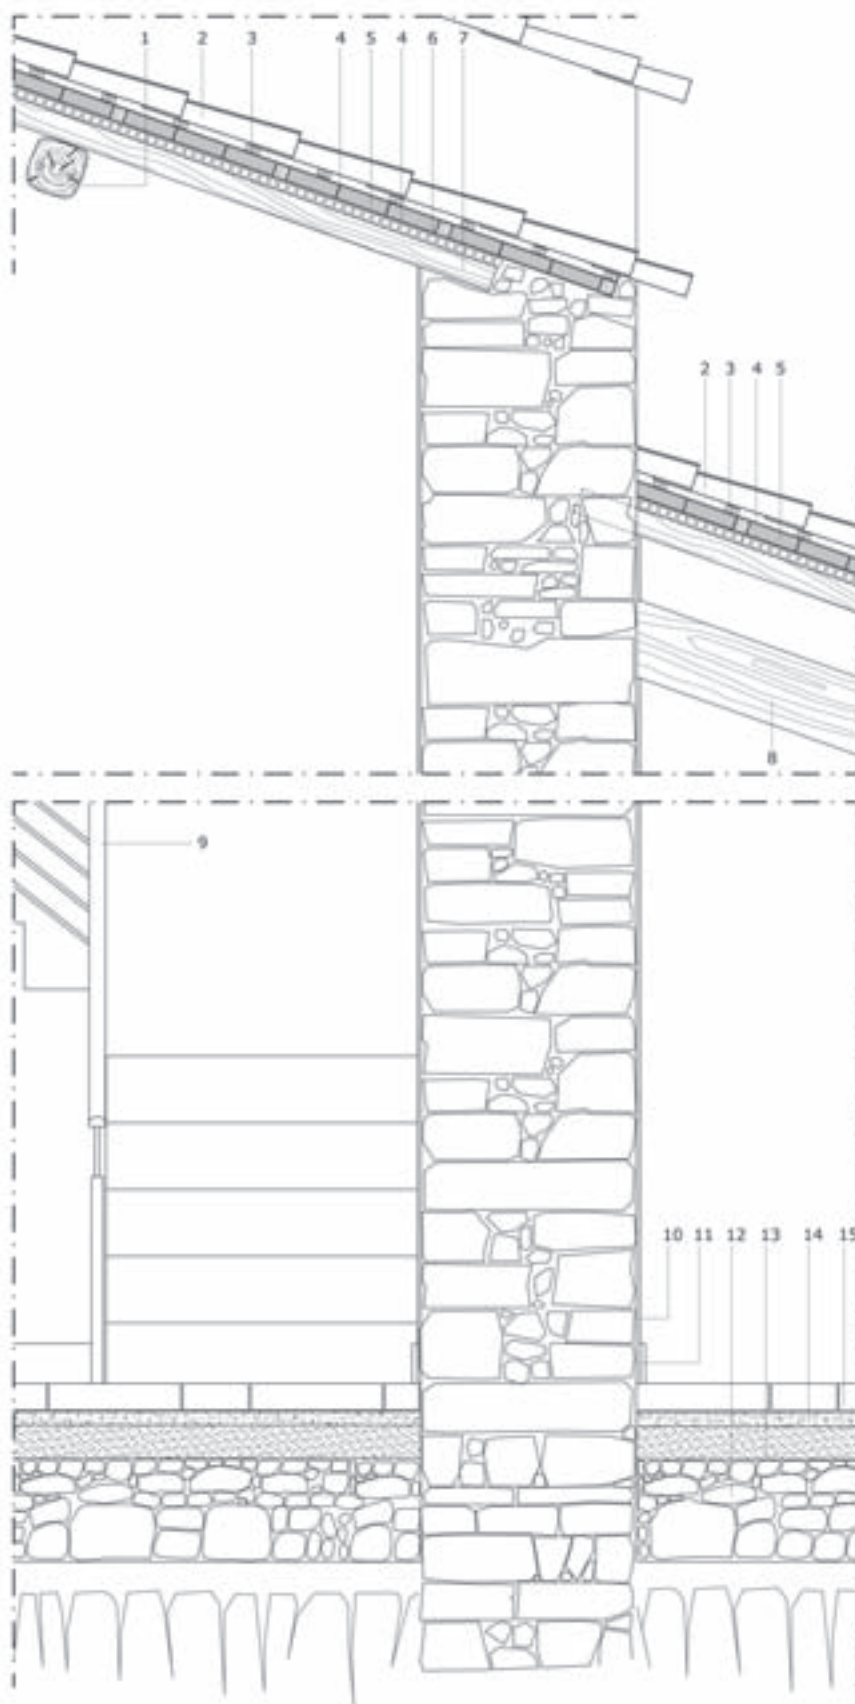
Dettaglio costruttivo, sezione verticale.
